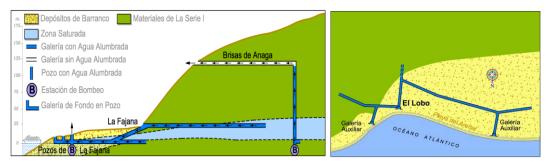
Izda: Perfil esquemático de las galerías Brisas de Anaga y La Fajana. Drcha: Planta de la de El Lobo.
